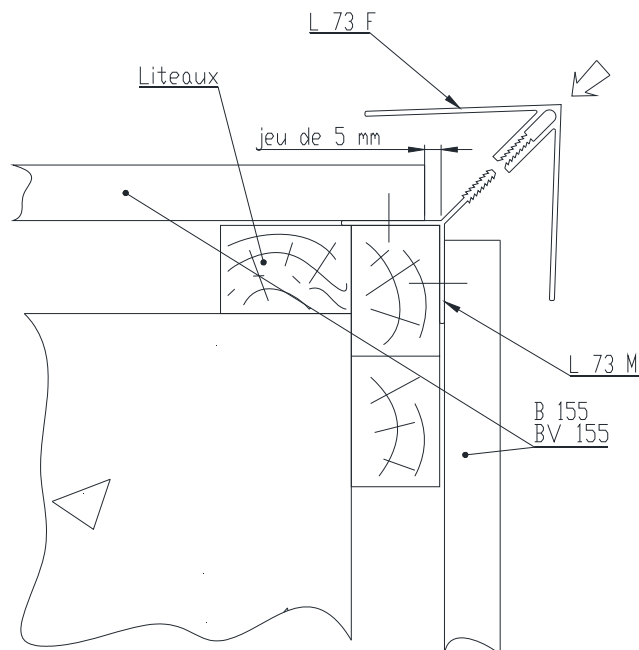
Disposition horizontale – Arrêt haut sous avancée de toit
